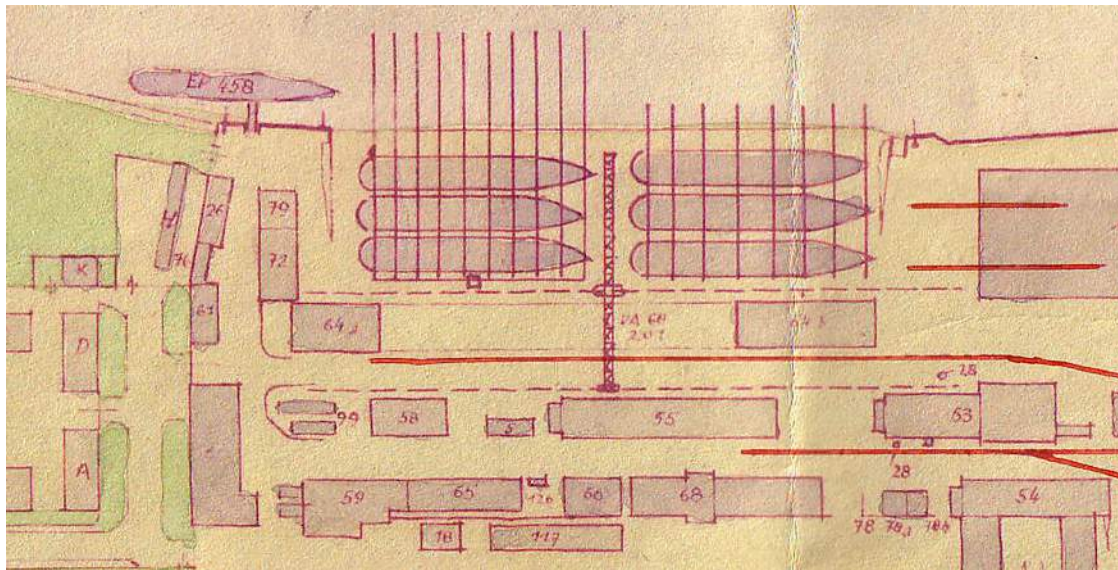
Darstellung als getrennte Objekte 64a und 64b auf dem Lageplan von 1948
